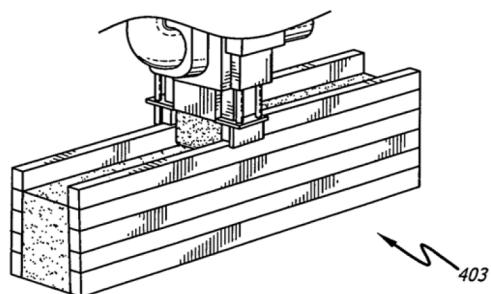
Общий вид рабочей головки портального 3D-принтера по патенту США US7641461B2
